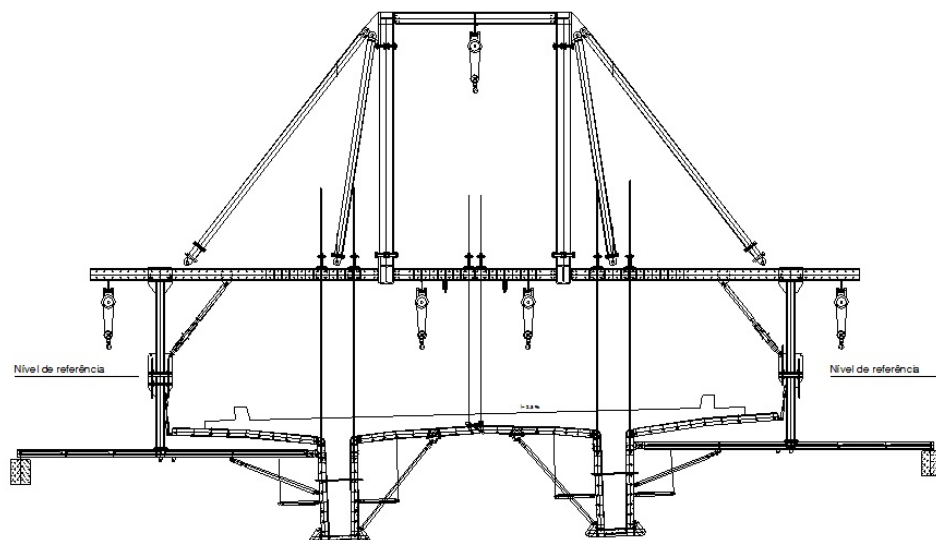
Cofragem para tabuleiro vigado (tipo π) com inclinação [7].
